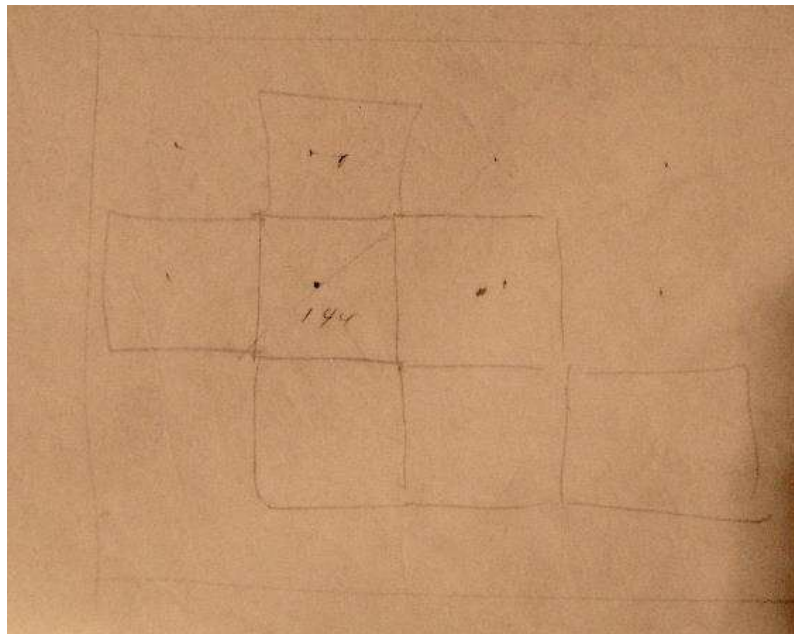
Detalle dibujo Parasol Houses, repetición o ensamblaje de la unidad estructural, la cual da forma en un orden reticular al resto del espacio vital de la vivienda.
